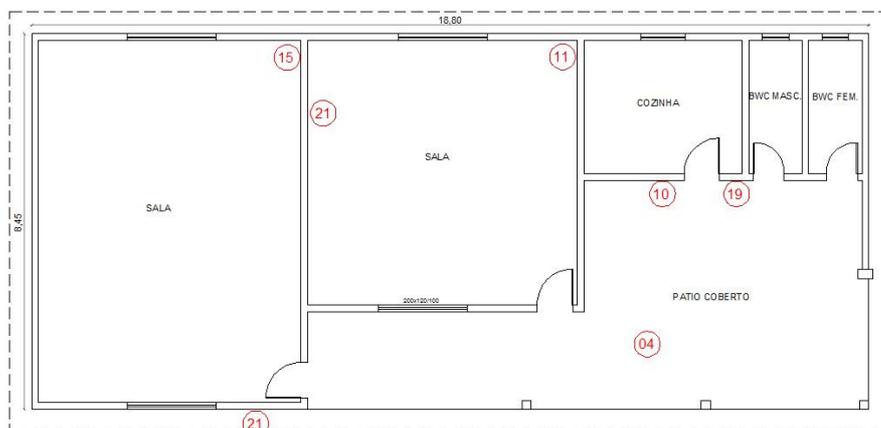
Planta Baixa creche Cinderela – Bairro Marili
